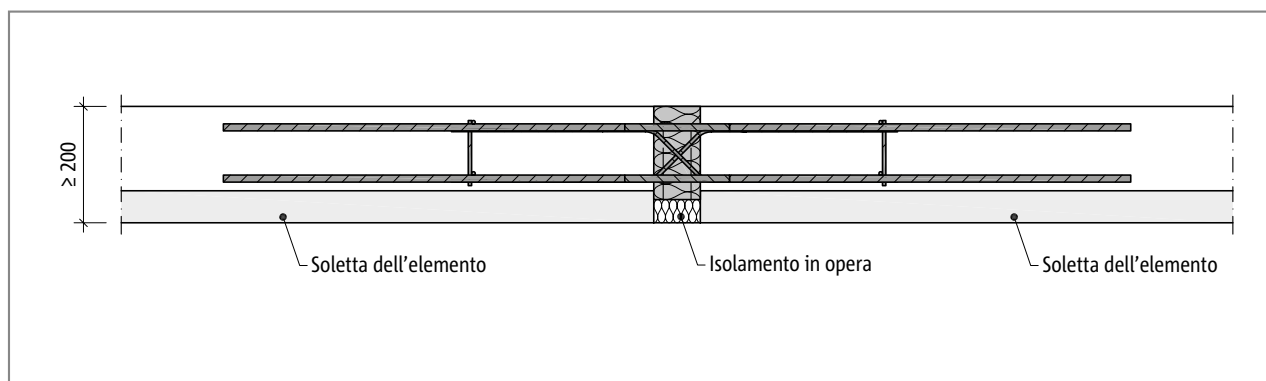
Schöck Isokorb® tipo D: Isokorb tipo D posato sul solaio dell'elemento.
